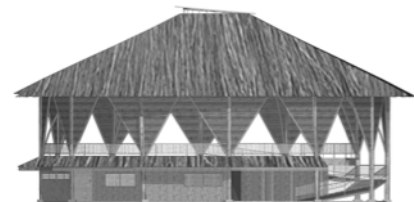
Tampak Ruang Kelas dan Laboratorium
